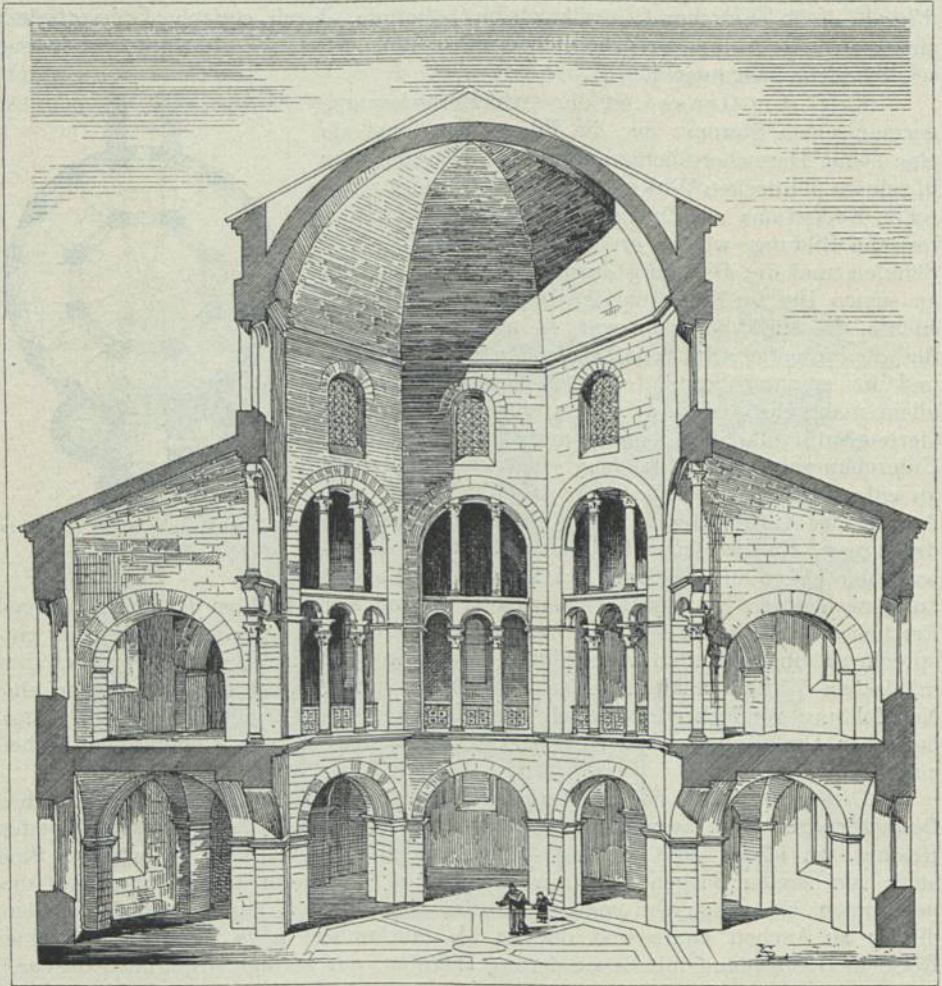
Durchschnitt des Münsters zu Aachen (Rekonstruiert)
